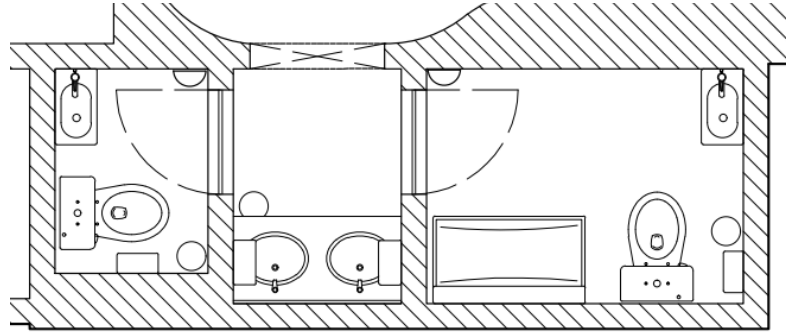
Planta das Instalações Sanitárias. Fonte: Autora, 2025
